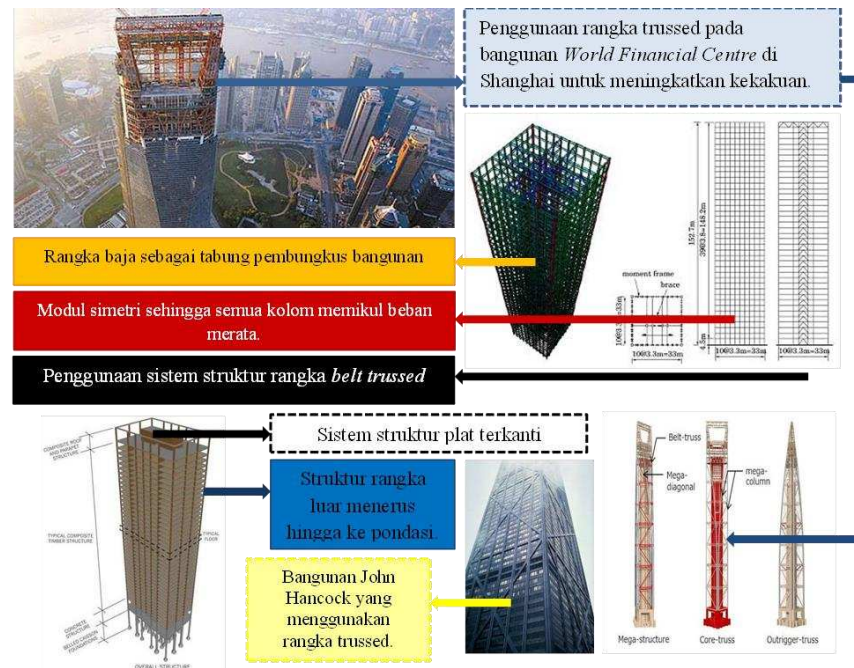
Struktur bangunan tinggi yang lazim digunakan
